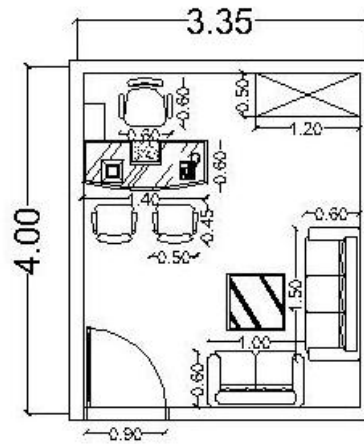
Studi Ruang Kamar Tamu Tipe *Executive Room
